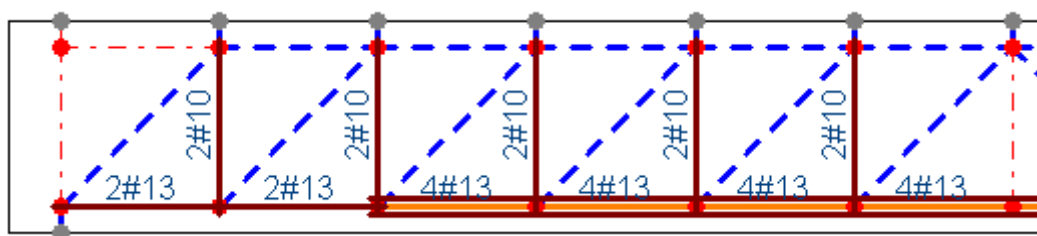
VB1 - Disposição das armaduras dos tirantes da treliça
